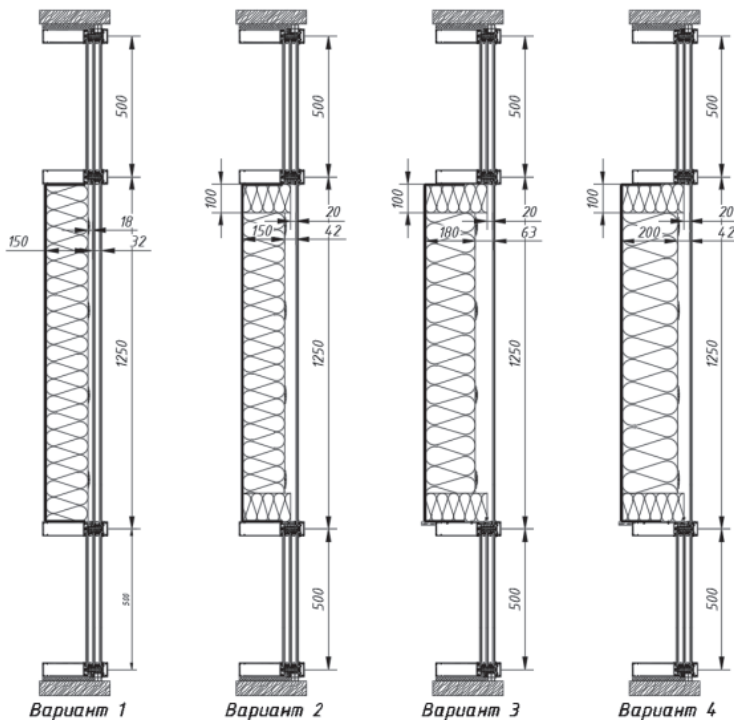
Конструкция фасадная светопрозрачная. Типы заполнений
